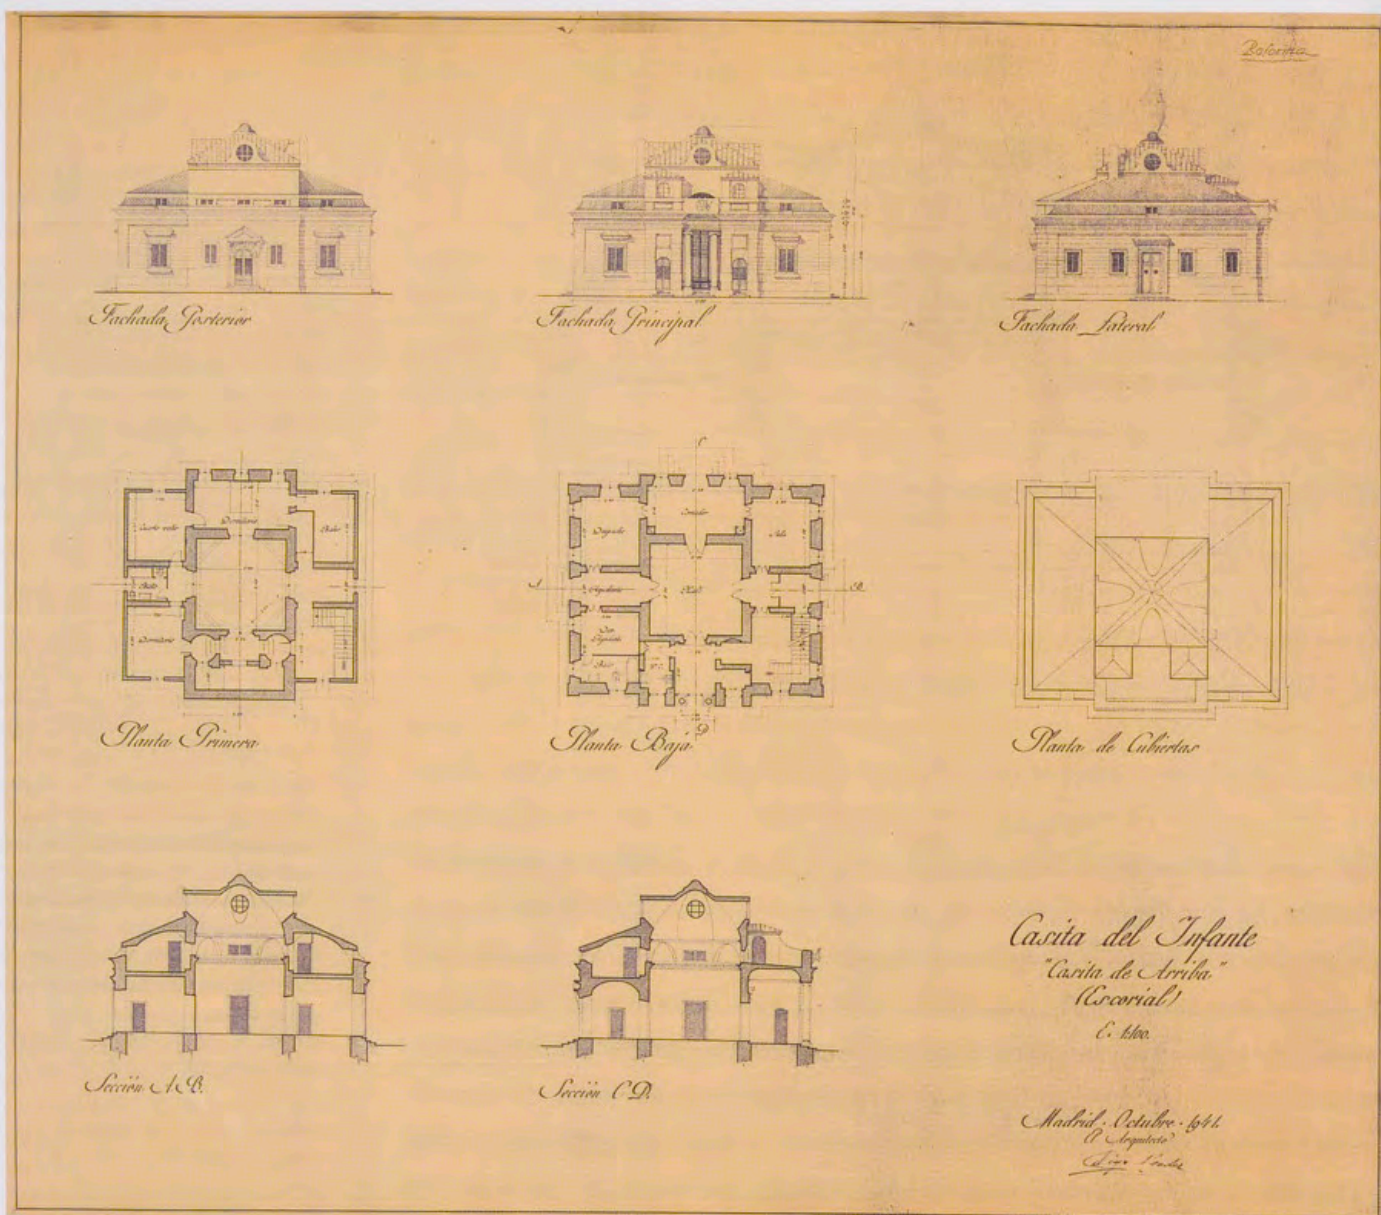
Diego Méndez (copia), Proyecto para la reforma de la Casa de Arriba: fachada posterior, fachada principal, fachada lateral, planta primera, planta baja, planta de cubiertas, sección AB (transversal) y sección CD (longitudinal). Madrid, octubre de 1941. Archivo General de Palacio, Planos, n.º 8853, Patrimonio Nacional.
